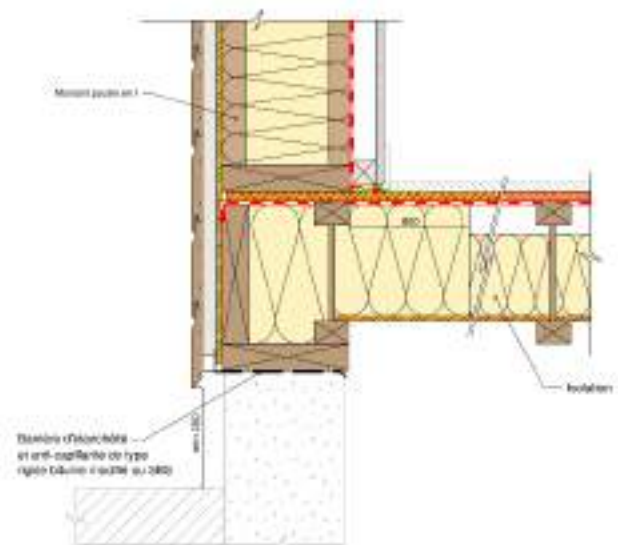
Liaison pied de mur extérieur / dalle bois avec poutres parallèles au mur
